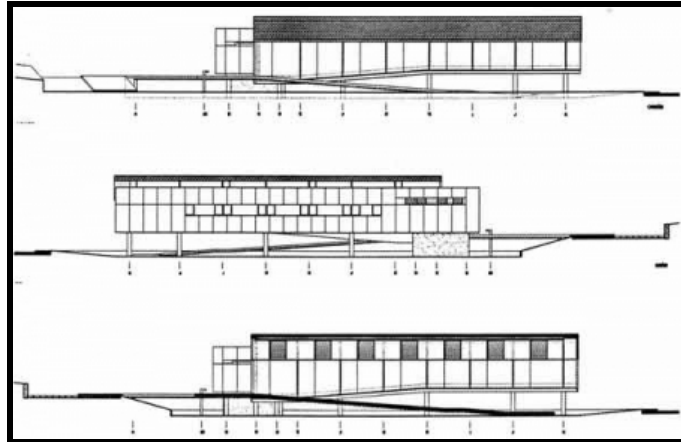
Fachadas del edificio, centro de salud en Domaio.
